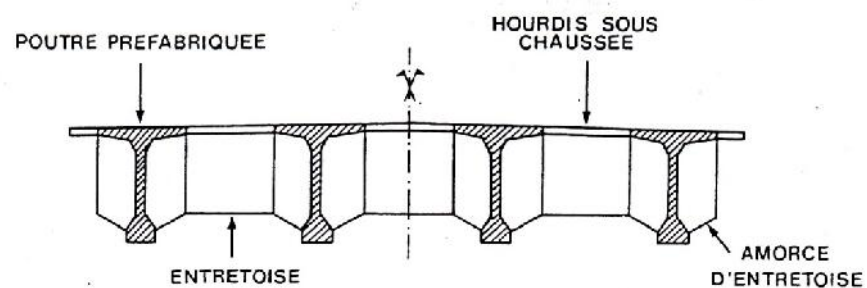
Coupe transversale de pont à poutres préfabriquées
